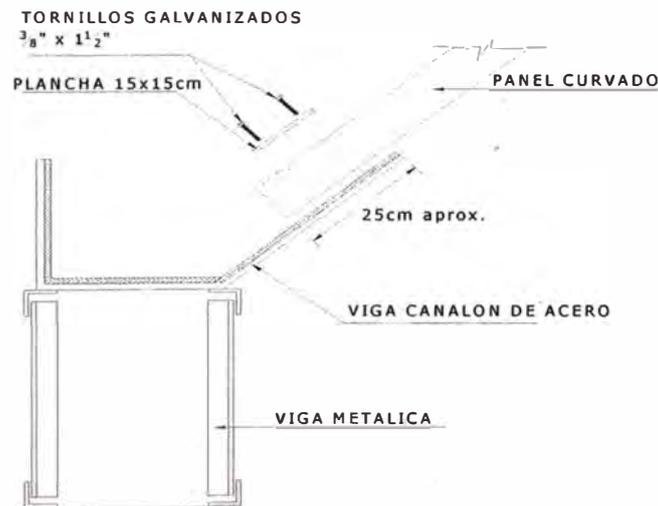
Anclaje de un arco en un sistema auto soportado.
